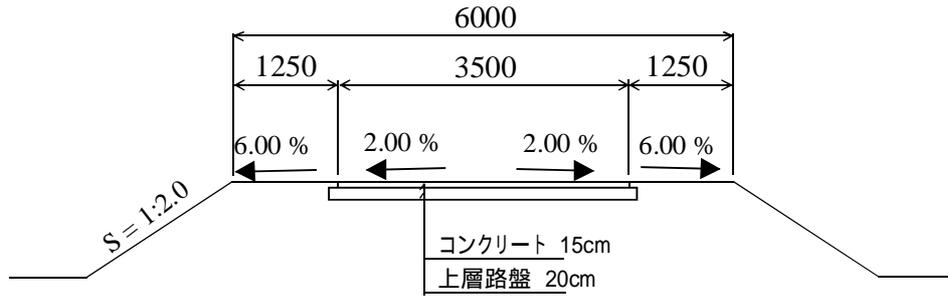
県道のコンクリート舗装（冠水する区間）
